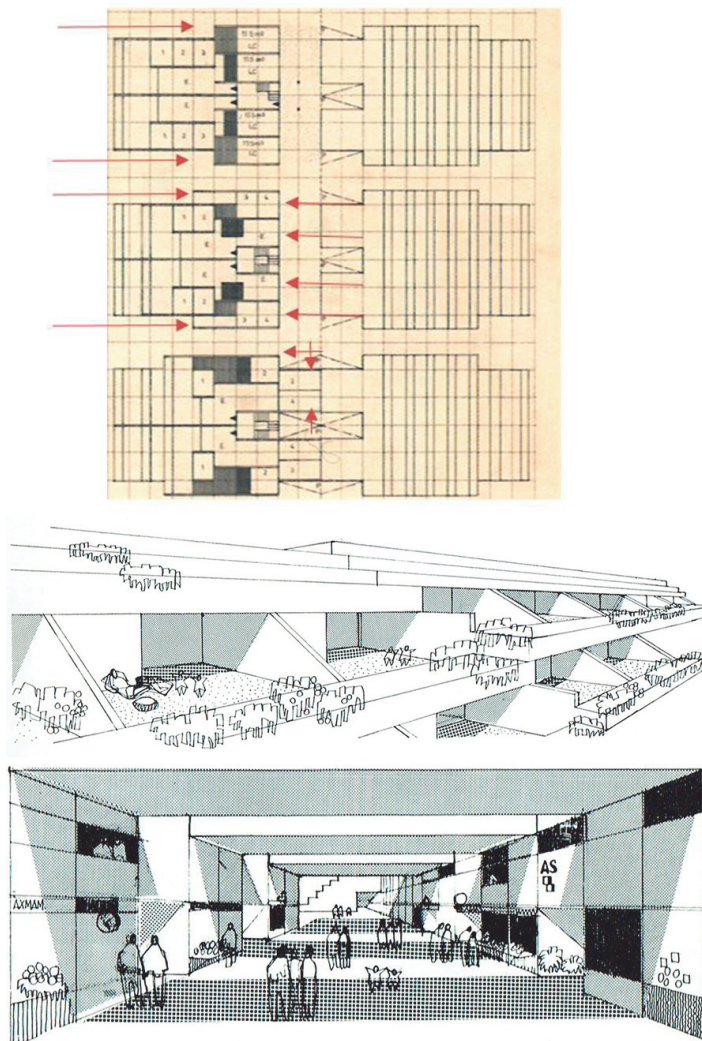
Izda.: Plantas baja, primera y segunda, con patios abiertos a fachada y traseros indicados con flechas. A partir de la tercera las viviendas pueden ser pasantes o seguir volcando al corredor central. Dcha.: Dibujos del concurso. J.A. Corrales y R.V. Molezún. Arquitectura, Xarait, p. 60.
